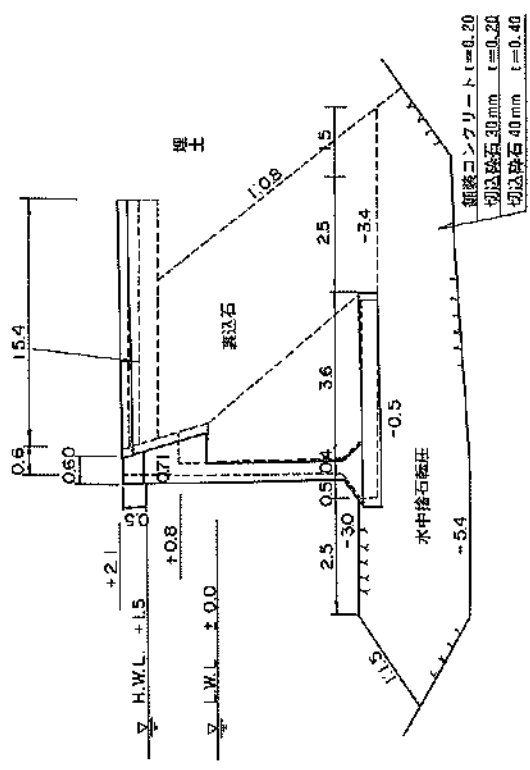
厚岸漁港（湖南地区）⑦—4.0m岸壁標準断面図および被災後の変形図(5)
